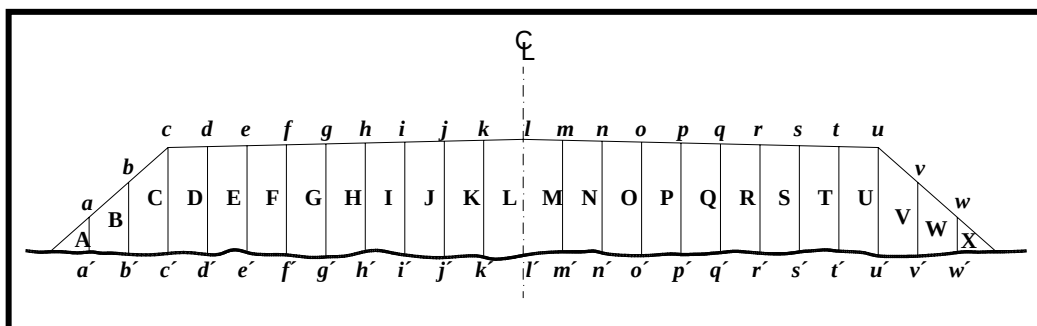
Sección transversal en terraplén subdividida en franjas verticales. (SCT)
